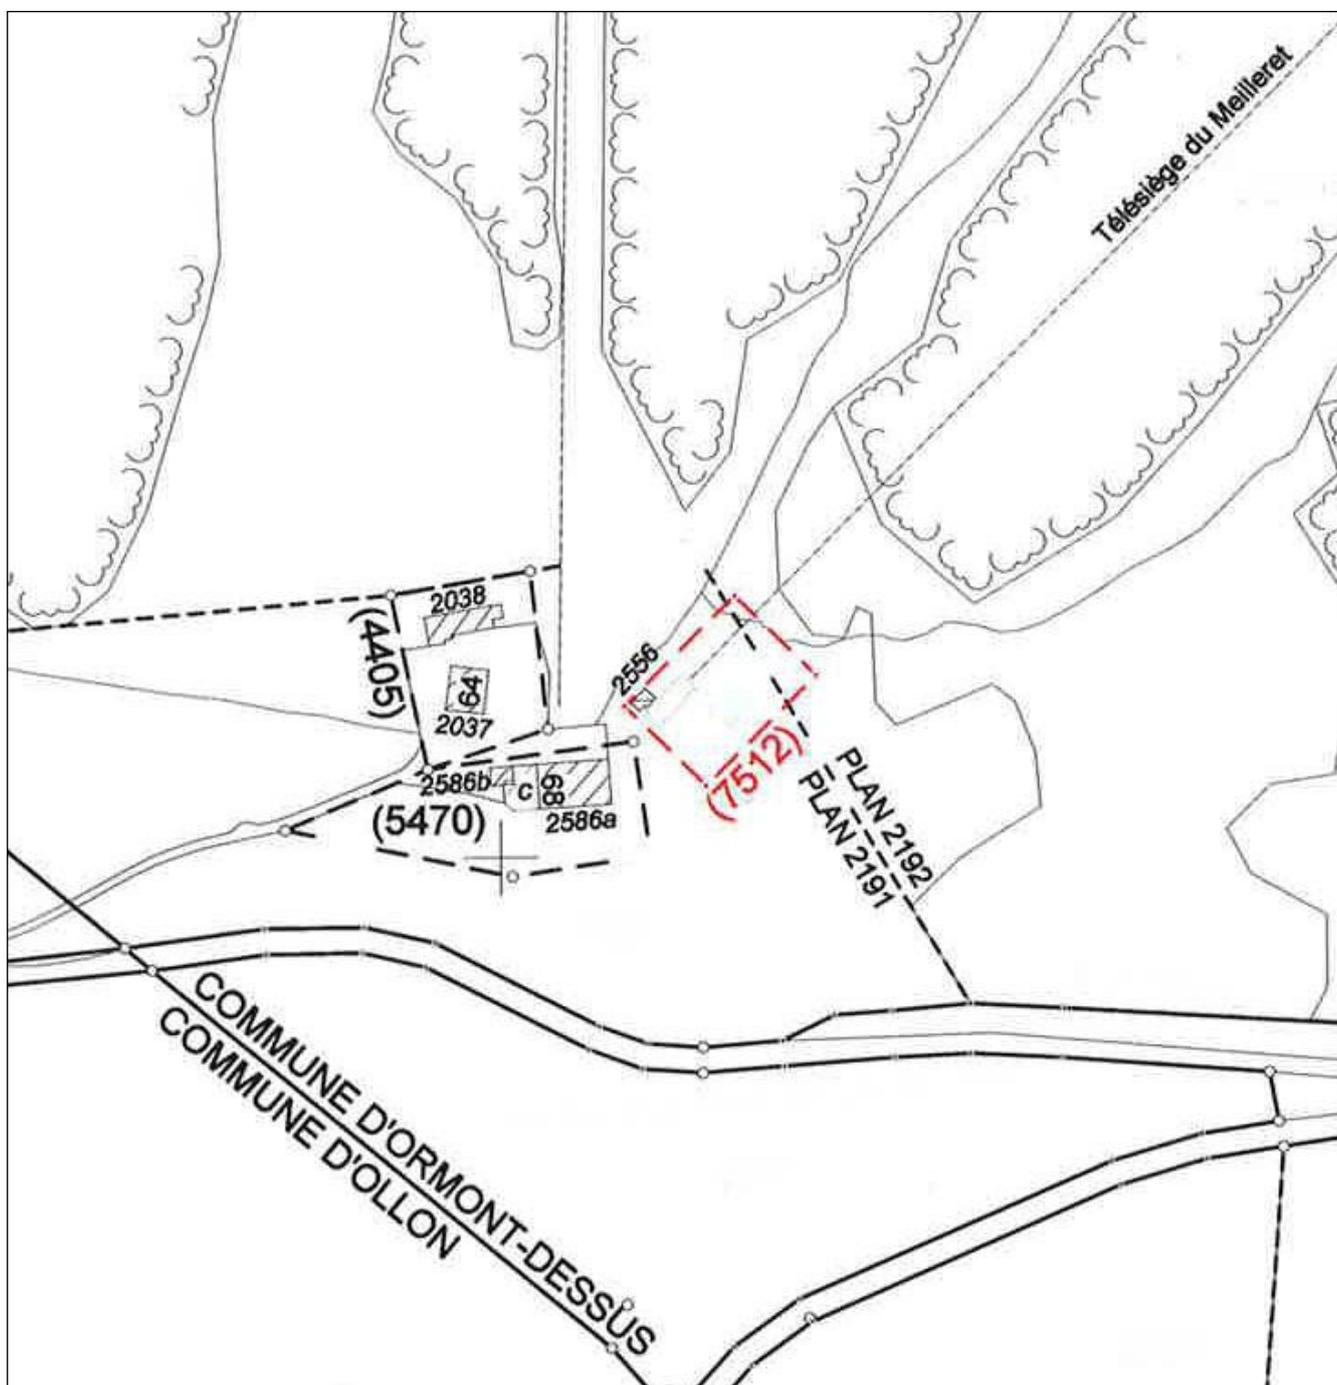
Plan de situation avec le droit DDP (7512) de 2453 m² existant en faveur de TVGD avec le DDP échu 4405 et le DDP 5470 en faveur de Diablerets-Immobilier SA
